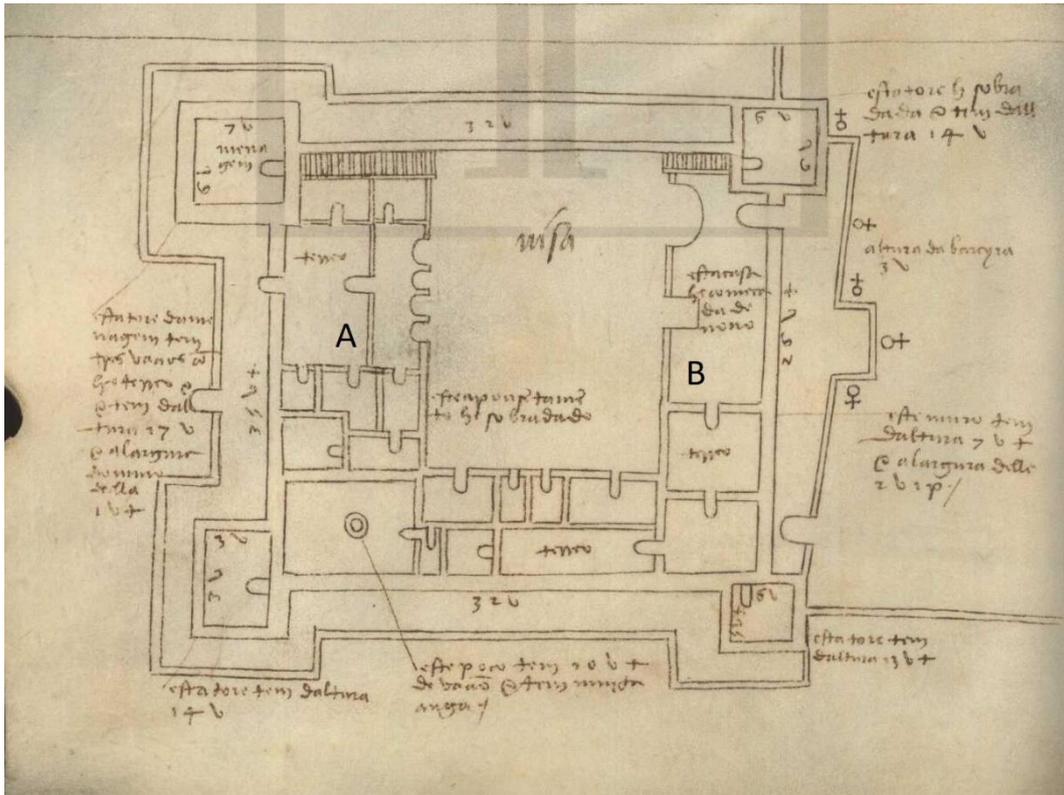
Planta do Castelo de Nisa: A – casa do comendador; B – nova casa do comendador, ainda em construção.
